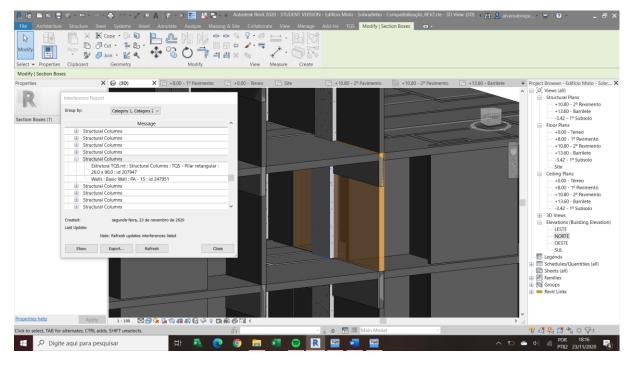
Detalhe de uma parede que atravessa um pilar. Imagem feita pelo autor.
